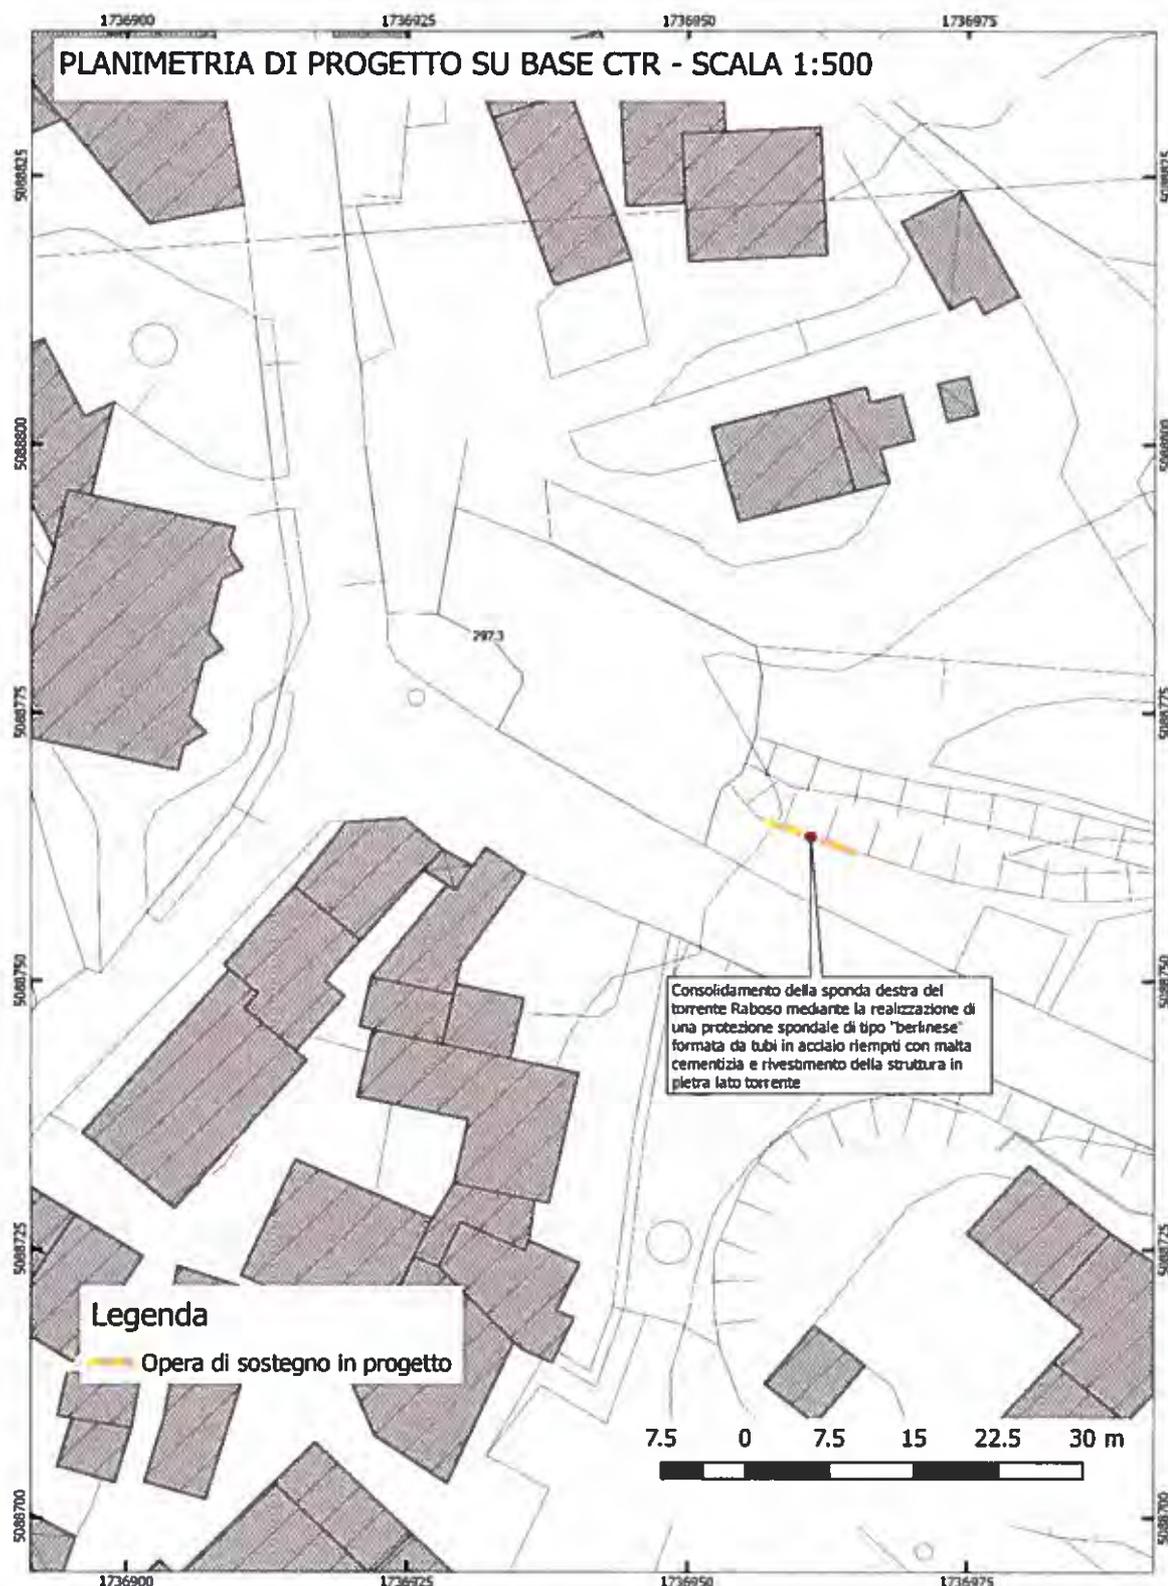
Intervento n.10 – Realizzazione di un muro d'argine a sostegno della sponda destra del torrente Raboso in località Guida - Planimetria di progetto
